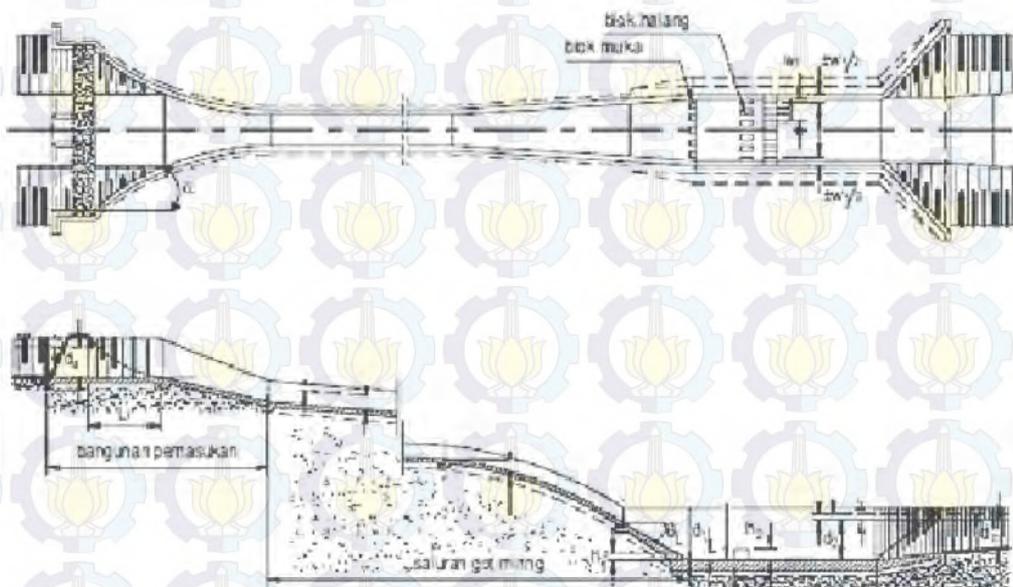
Potongan Memanjang Bangunan Terjun (KP-04 Bangunan, 1986)
